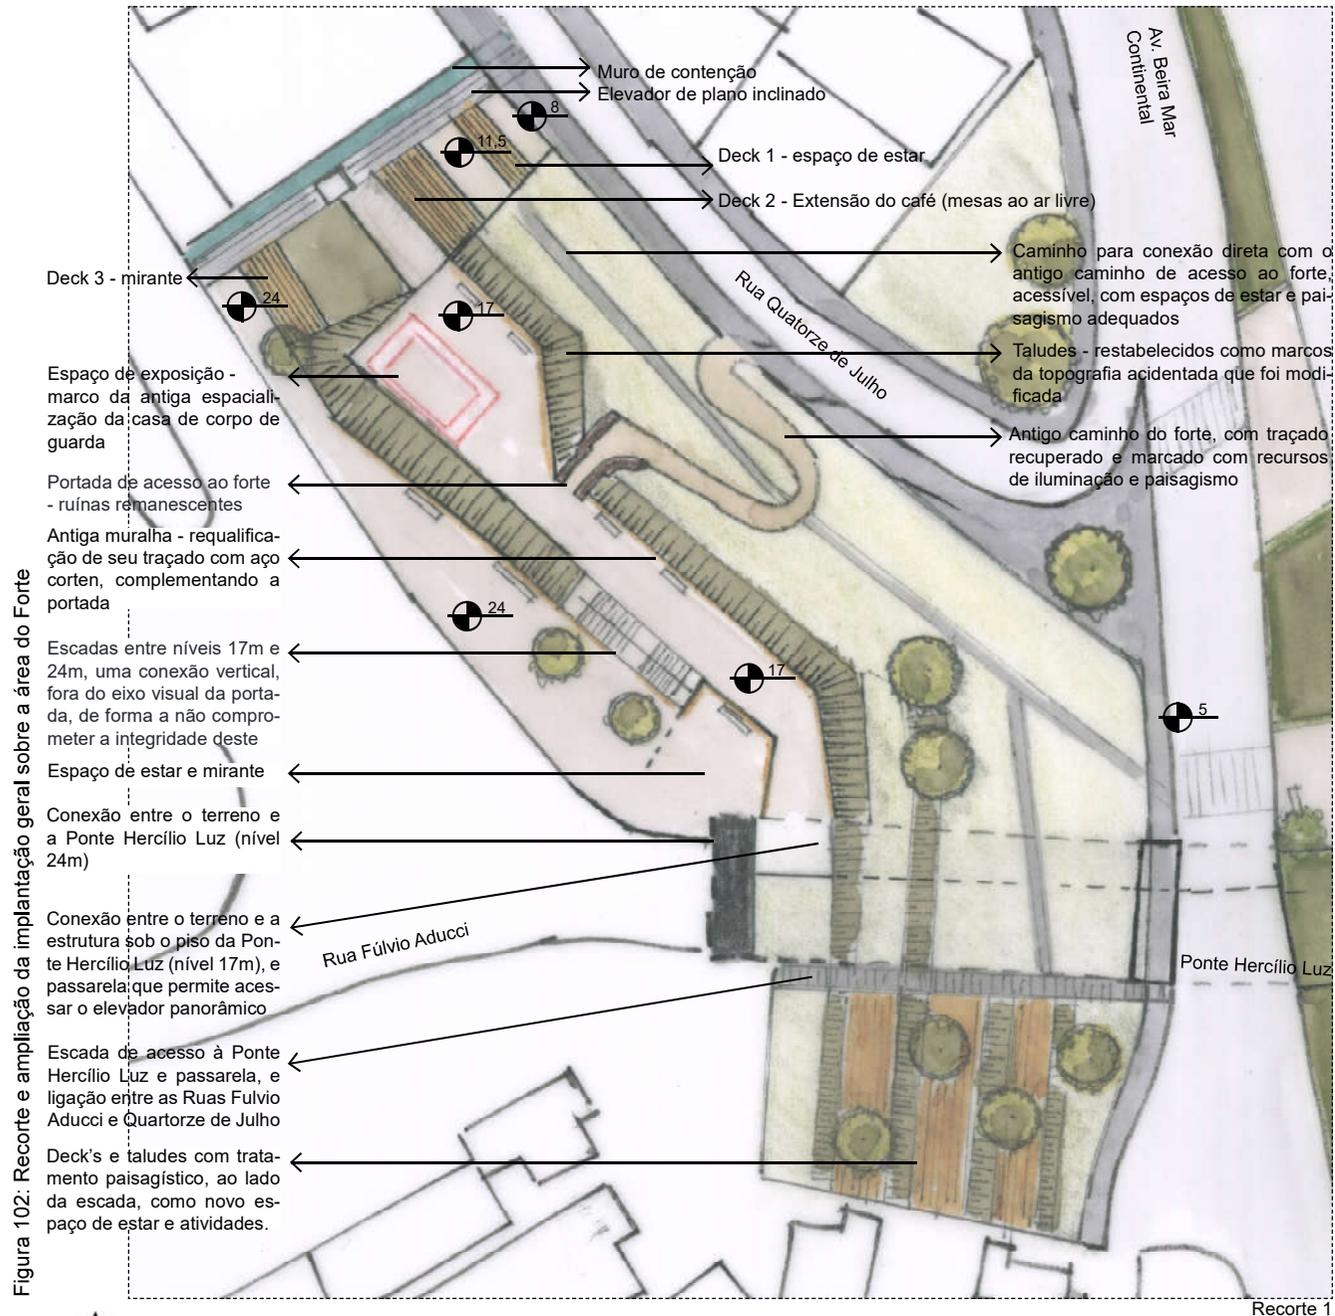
Recorte e ampliação da implantação geral sobre a área do Forte
